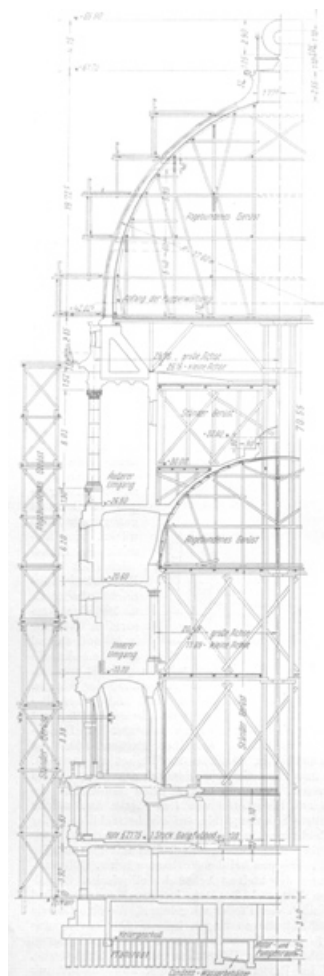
Gerüstplan (Emperger 1914, S. 76).
